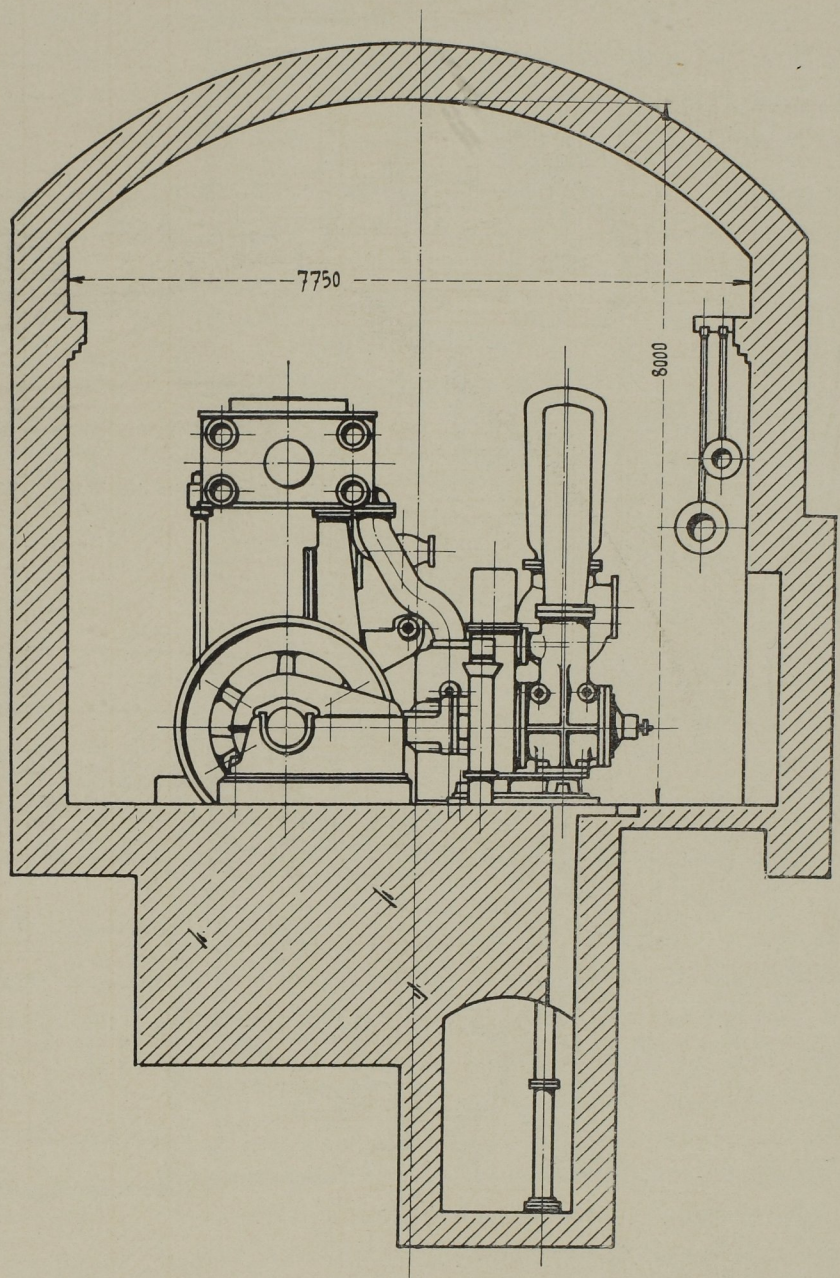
Querschnitt durch den Maschinenraum und Seitenansicht der Pumpmaschine. Massst. 1:80.
